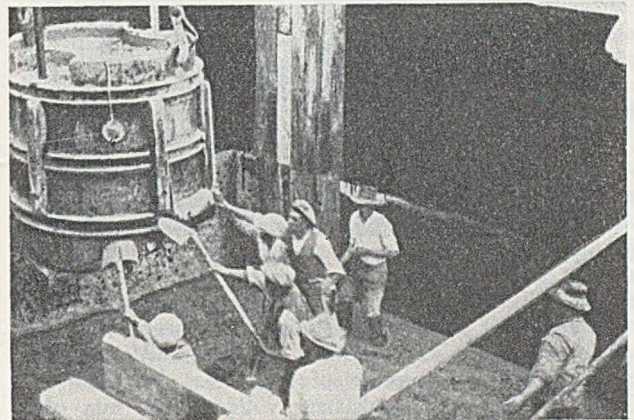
Betonieren eines Abschnittes der Nordmole mit 2-m³-Kübeln.
